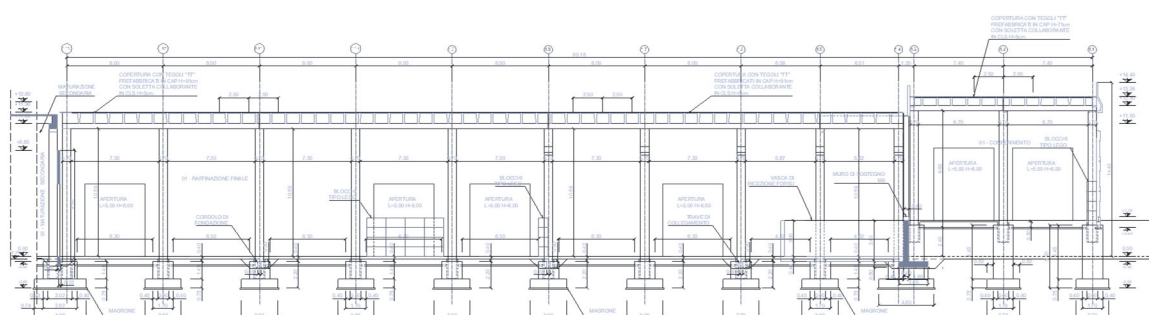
SEZIONE LONGITUDINALE CONFERIMENTO E RAFFINAZIONE
